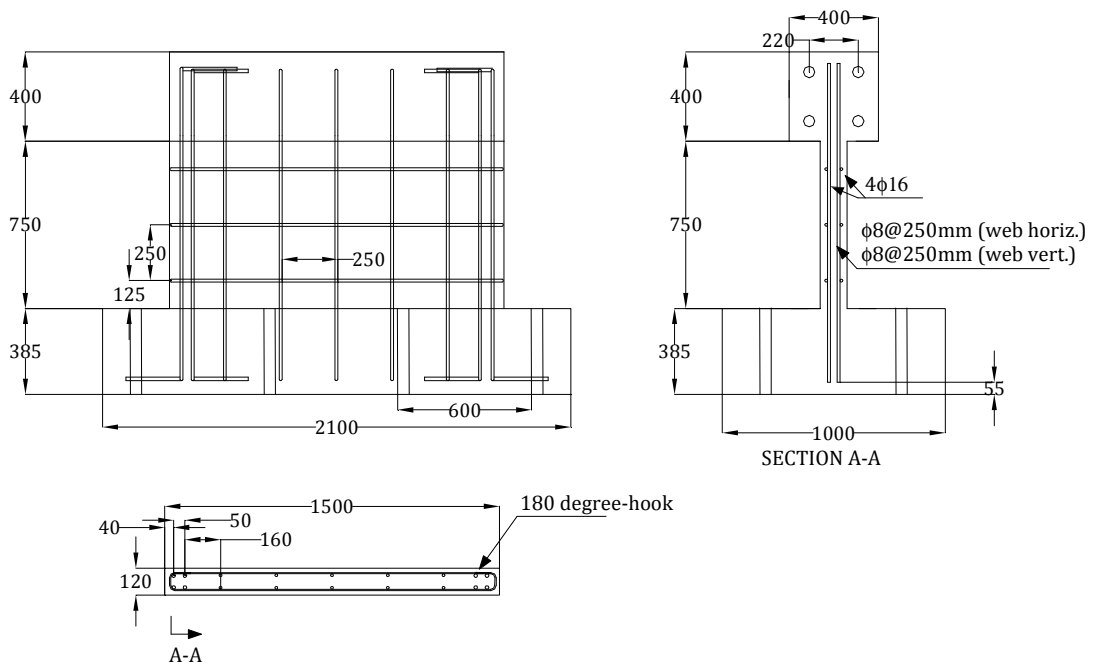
Geometría y detalle de armadura de muro Tipo 1.
